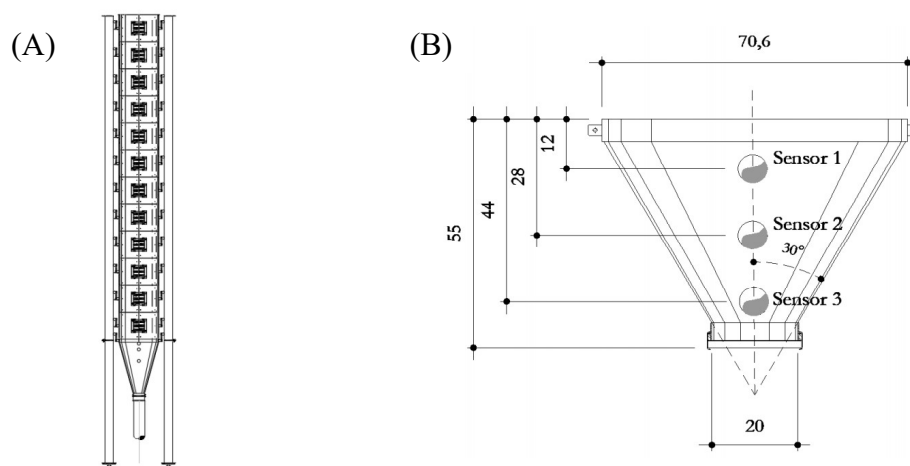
Vista esquemática geral do silo piloto (A) e vista frontal da tremonha (B).
